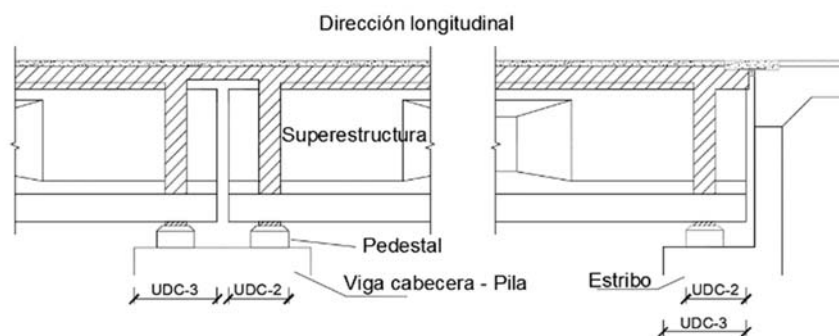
Longitud de apoyo disponible para la superestructura, en Pila y Estribos
